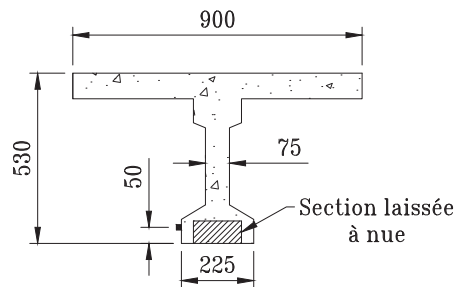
Section de coupe des torons et installation de l'accéléromètre en position B5 pour la poutre PBP-2
